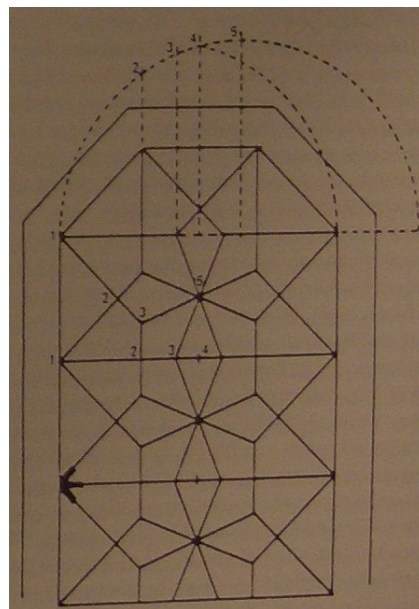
Konstruování jednoduché kroužené klenby
